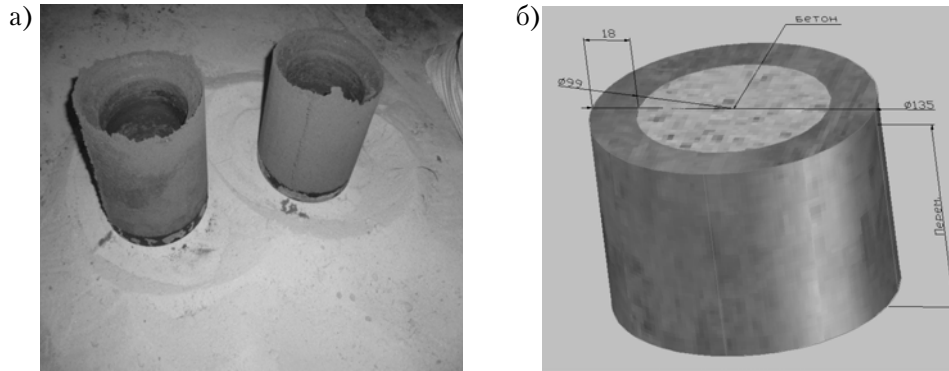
Изготовленные образцы: а – фрагмент несъемной бетонной опалубки; б – труботетон.
